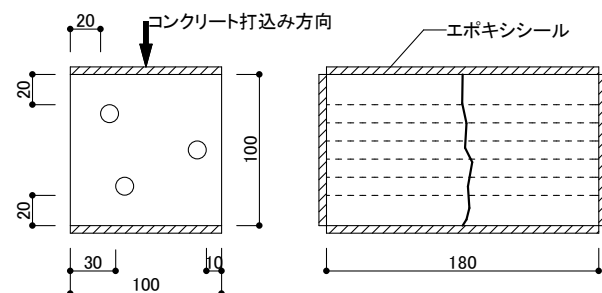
貫通ひび割れ試験体(試験体タイプ A)
